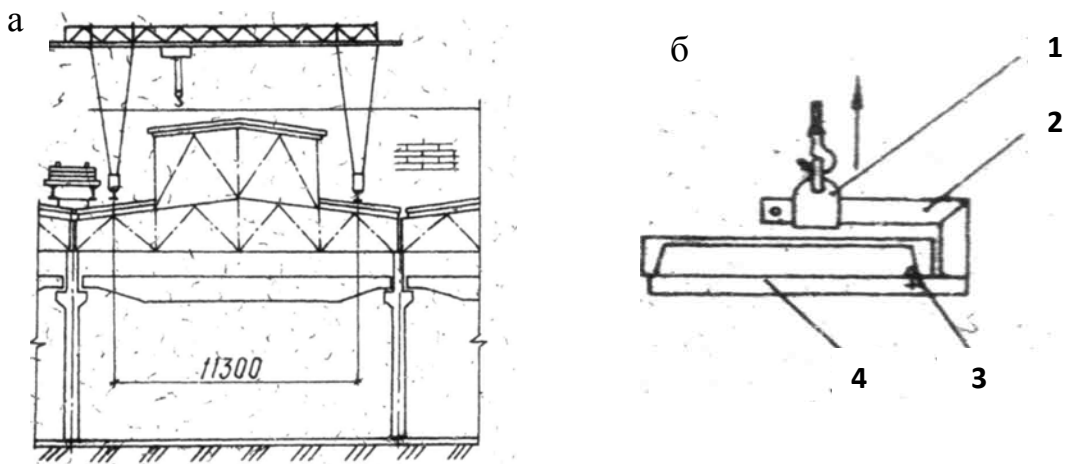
Демонтаж плит покриття промислової будівлі покрівельним краном:
